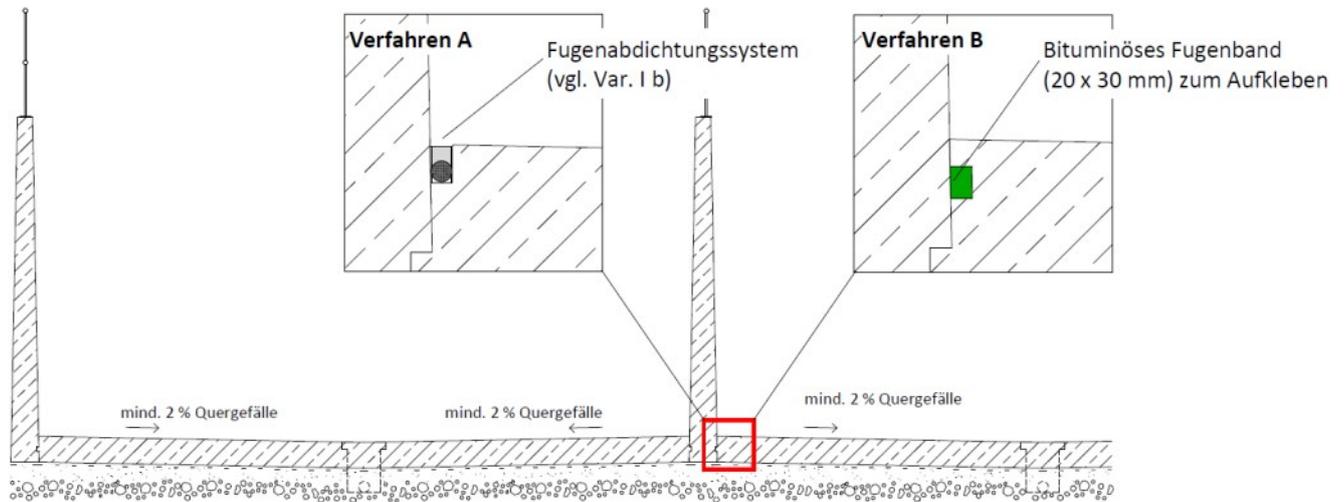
Ortbeton - Betonfertigteil (gerade Wand)
